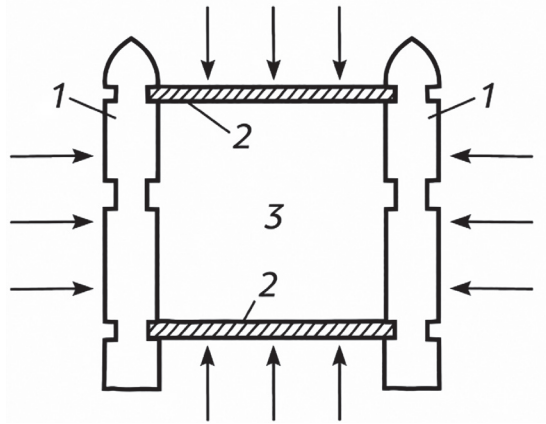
Escenario de cálculo: reparación de la compuerta de emergencia.
